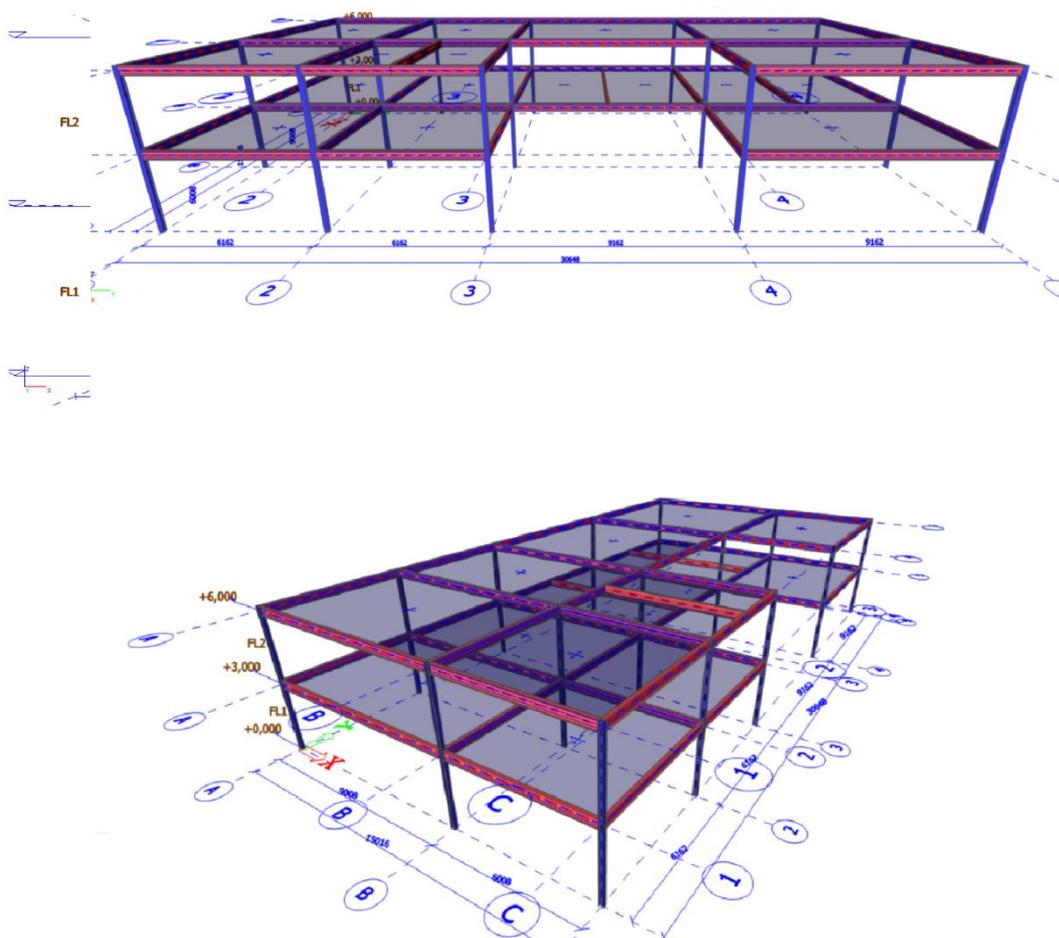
Estrutura de Aço - Lançamento Estrutural
